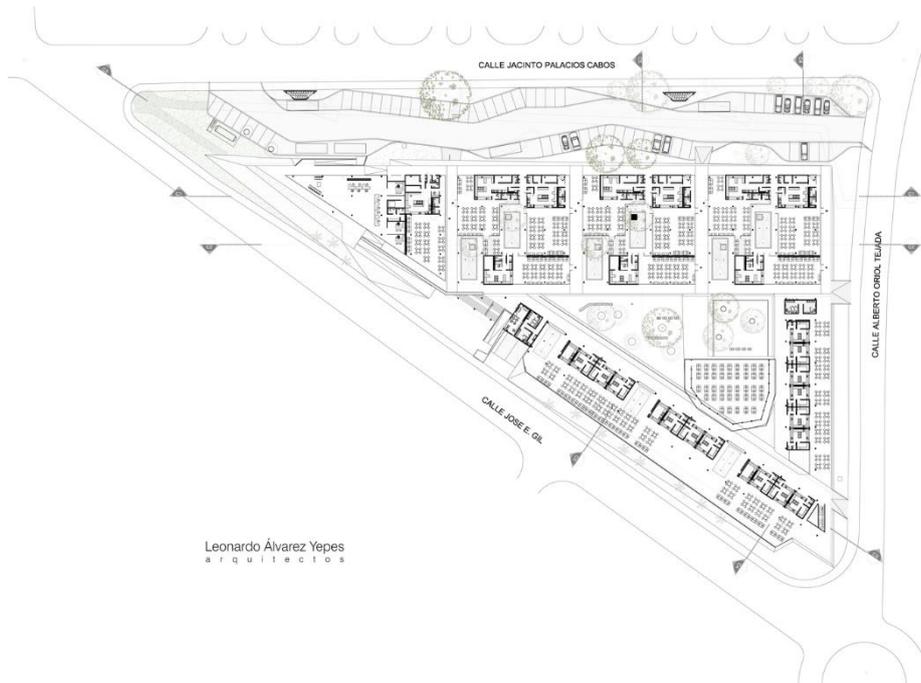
Vista planta del edificio comercial la Plaza Ciudad
